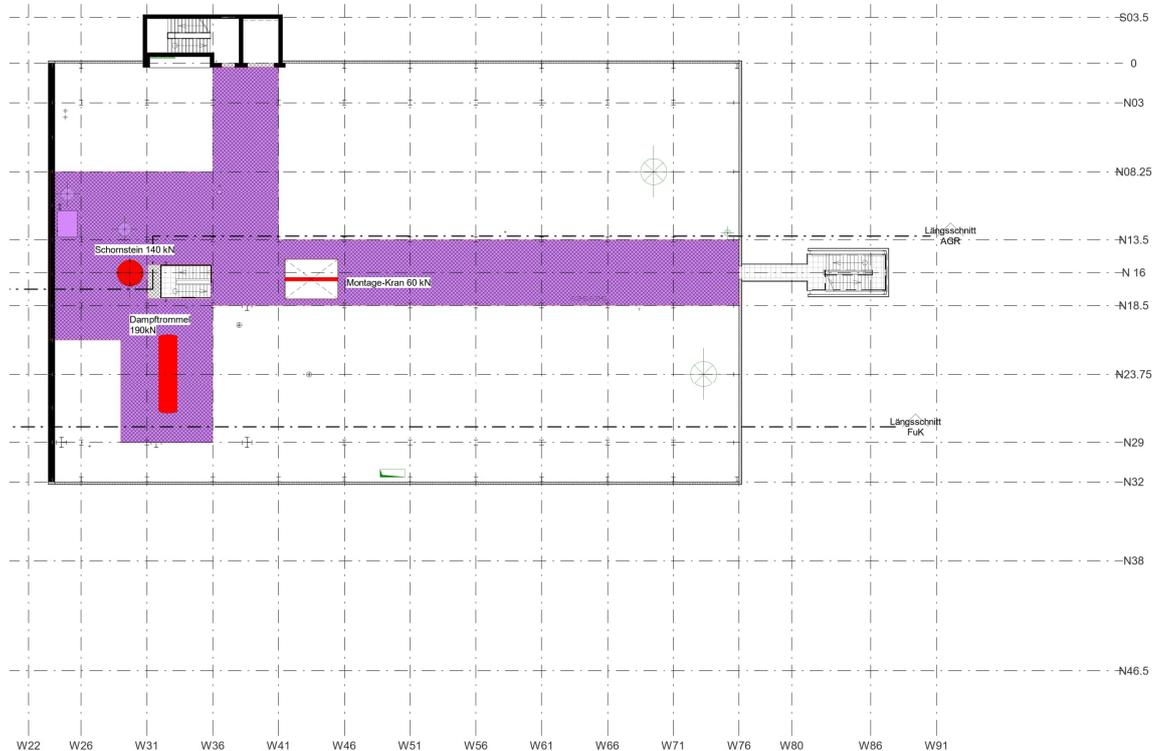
Nutzlasten Grundriss +39.60m
